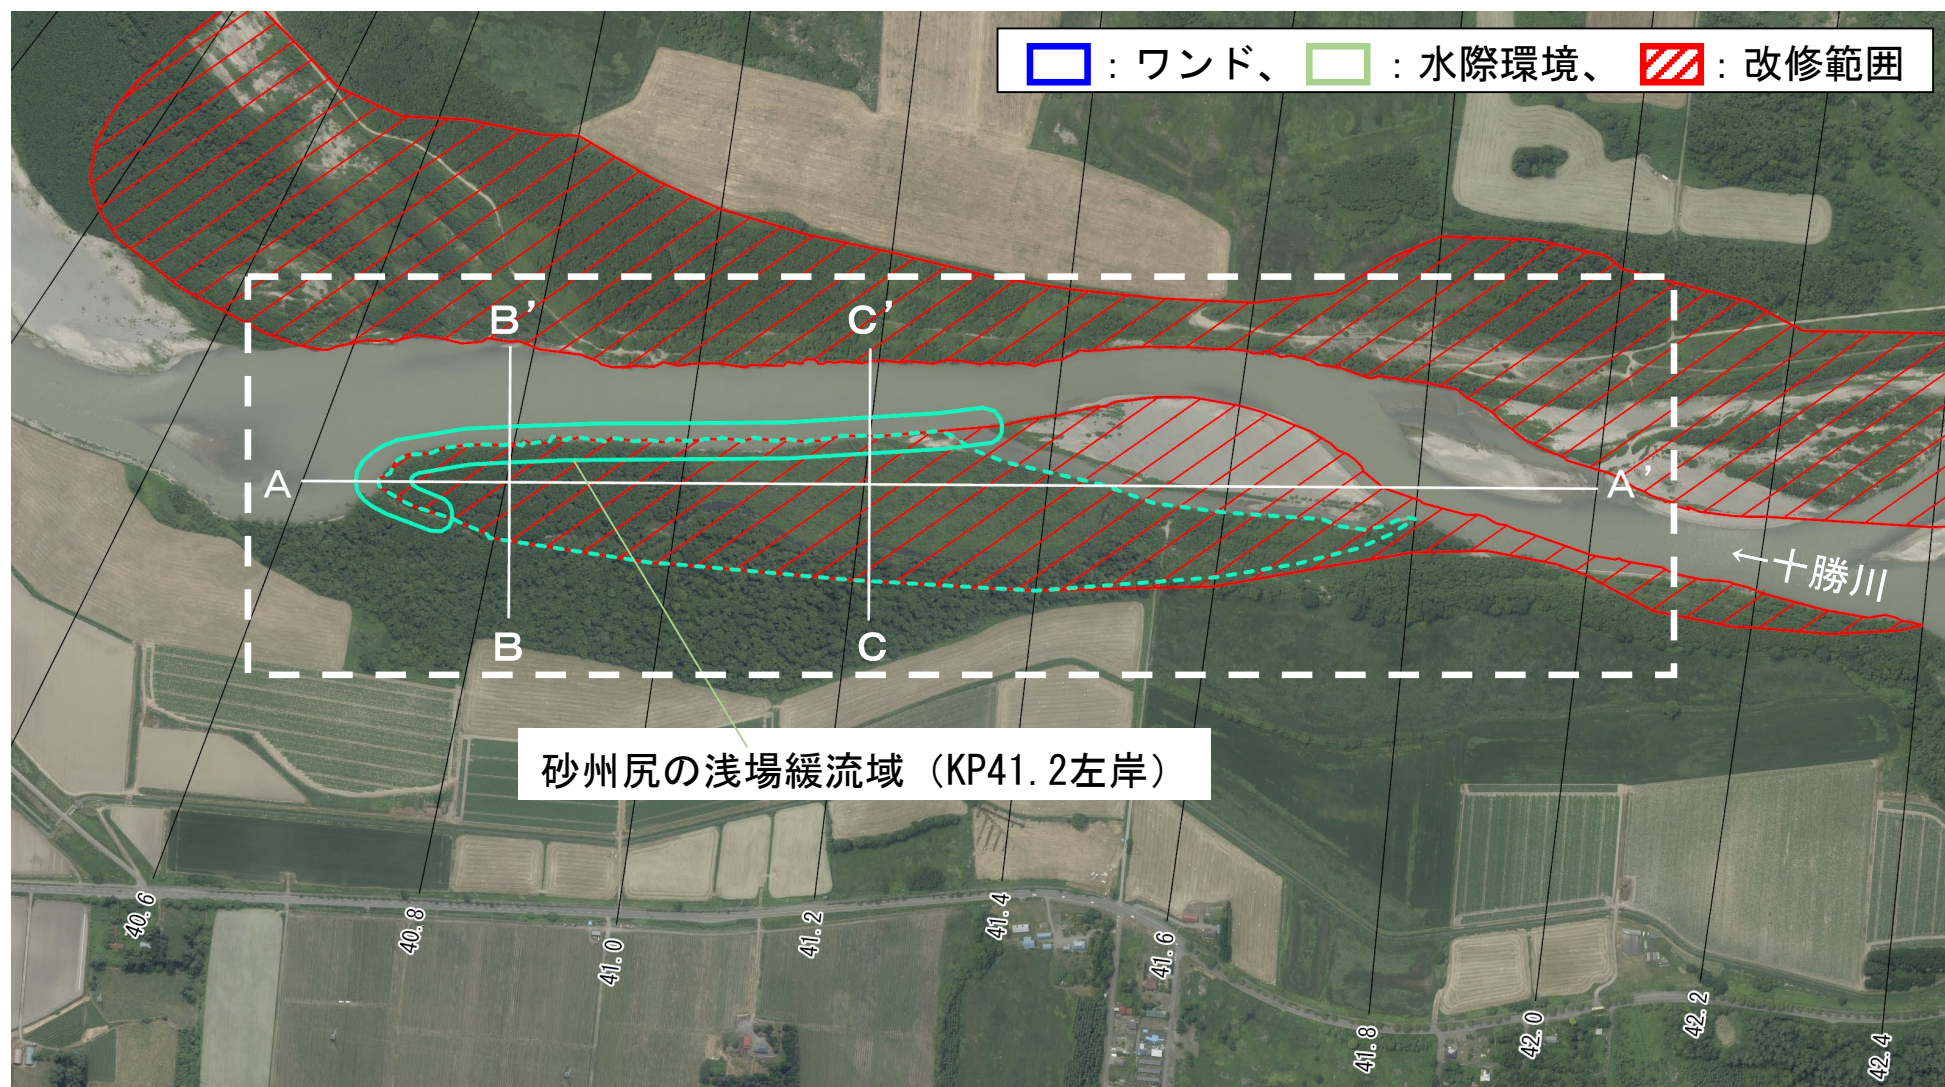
砂州尻の浅場緩流域 (KP41.2 左岸) の平面配置図
